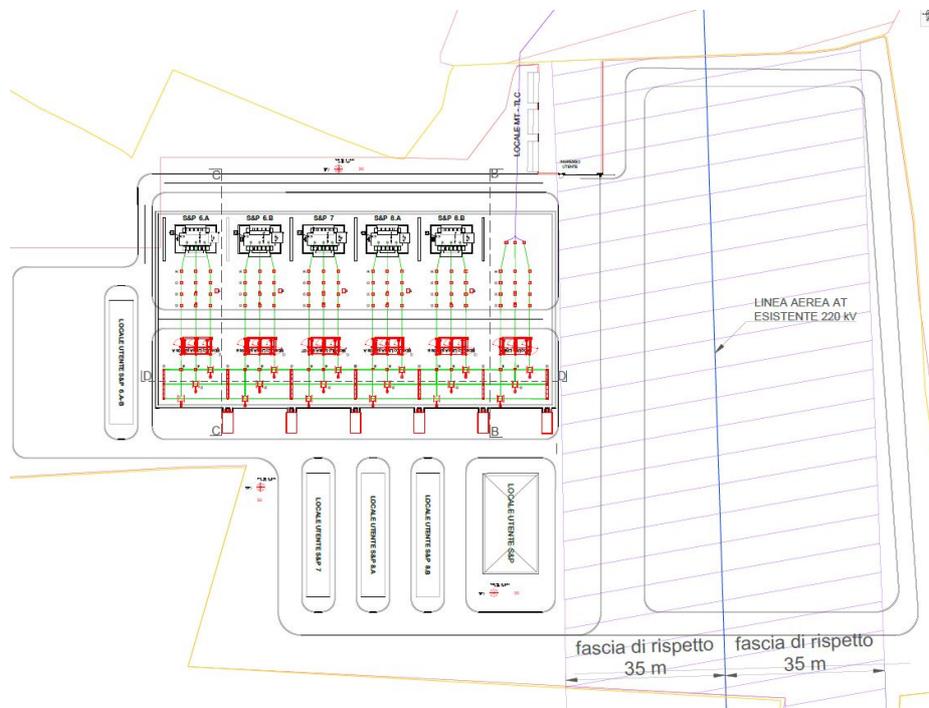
Pianta elettromeccanica generale – Stazione utente
